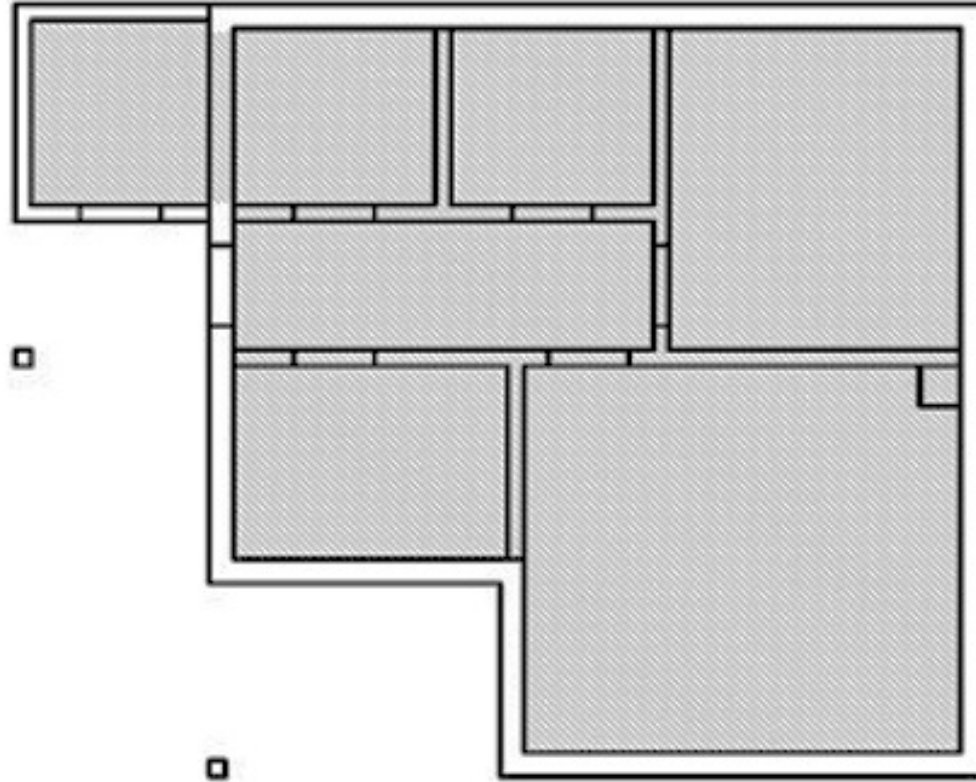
Eksempel på bruksareal (BRA) skravert på plantegning
